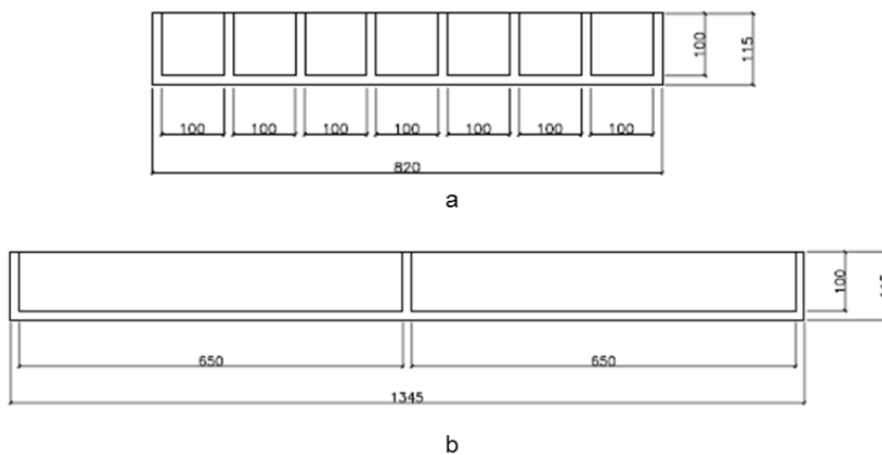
Detalhes da fôrma para vigas com dimensões em mm: (a) corte A-A'; (b) corte B-B'.
